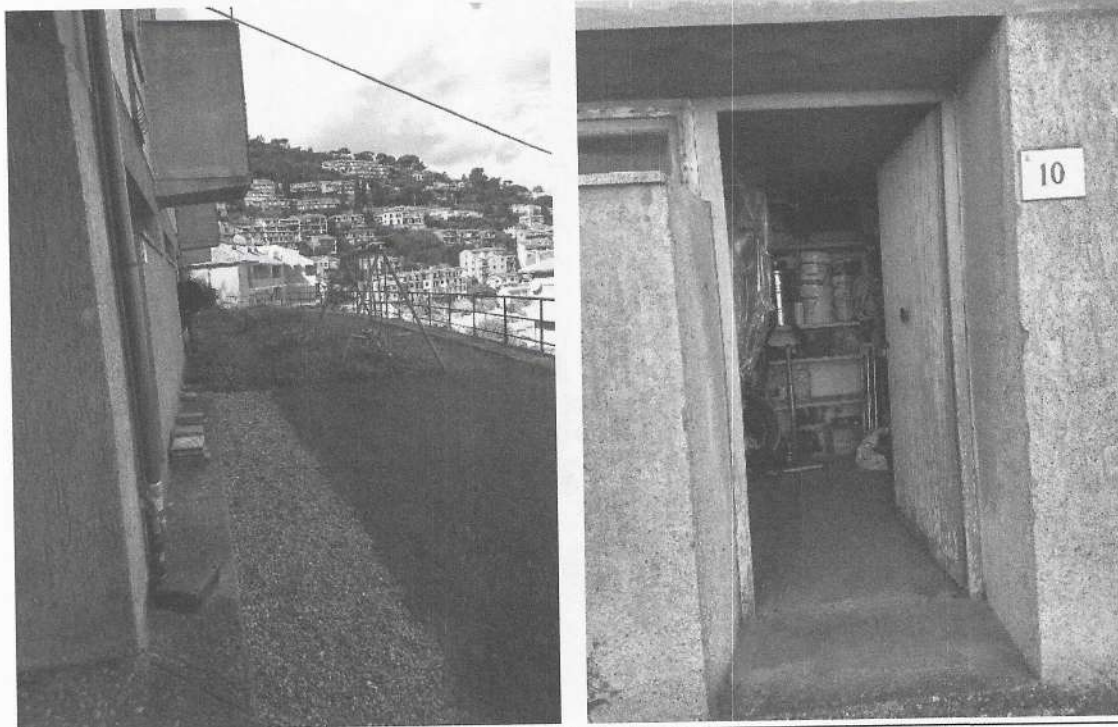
e 35: Vista esterna della corte comune al piano seminterrato dalla quale si accede al locale cantina e dell'ingresso alla cantina stessa.
